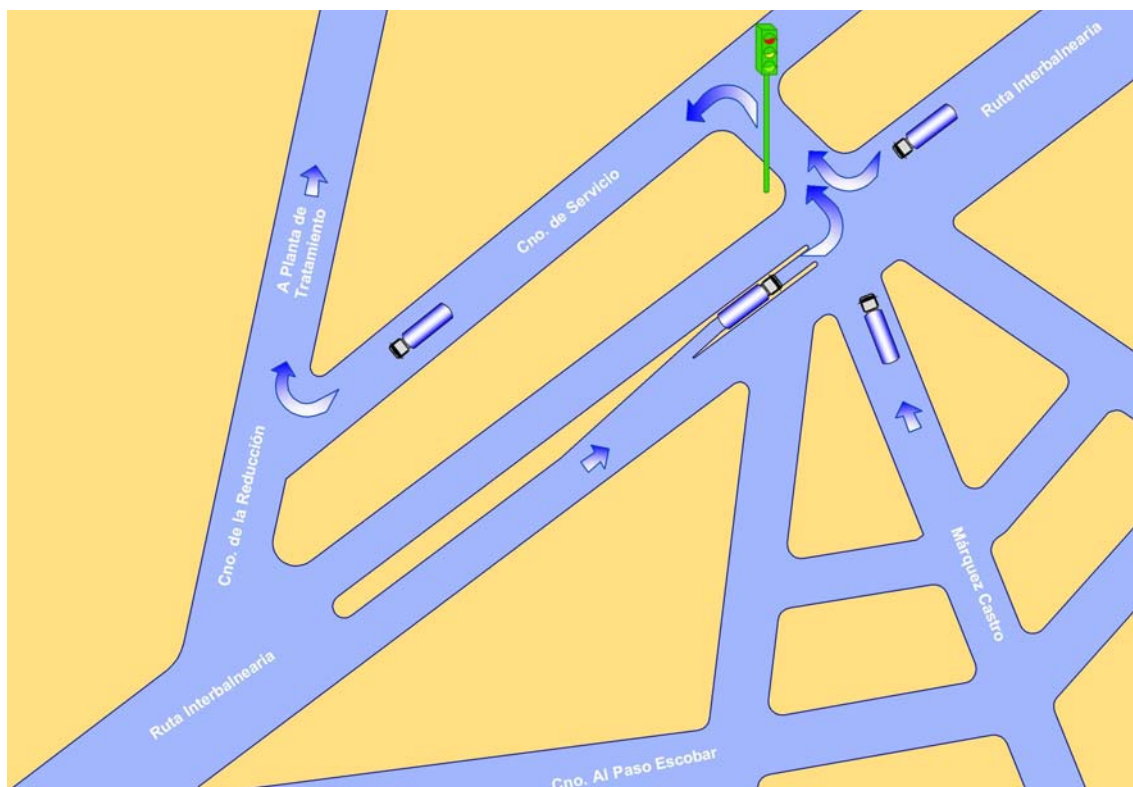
Croquis de la solución de acceso vial a la planta de tratamiento
